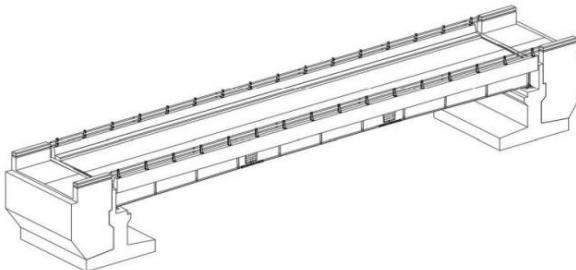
Potongan Melintang Pada Orpit Jembatan
